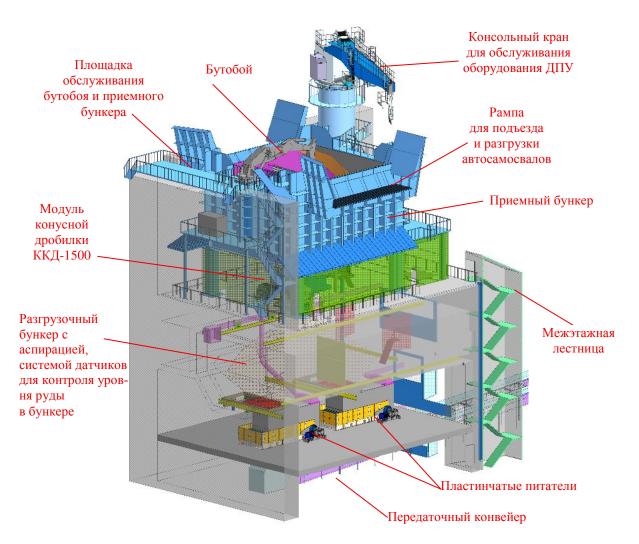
Компоновка высокопроизводительной ДПУ-6500 (нижняя часть выполнена на опорных железобетонных конструкциях)
